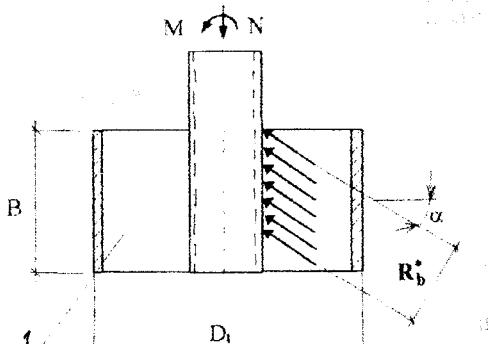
Розрахункова схема для встановлення навантаження руйнування від зрізу бетону замонолічування: 1 – бетон замонолічування
